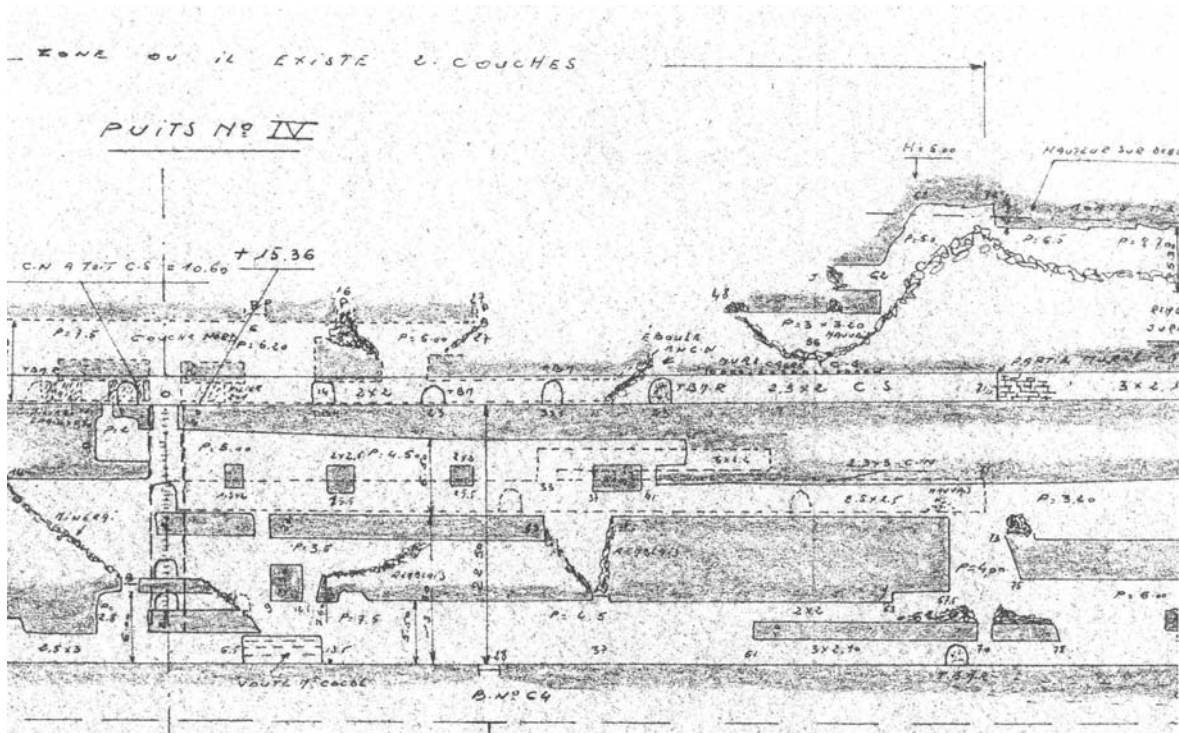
Travaux du flanc nord près de l'entrée de la galerie de niveau B (coupe longitudinale dans le plan de la couche)
